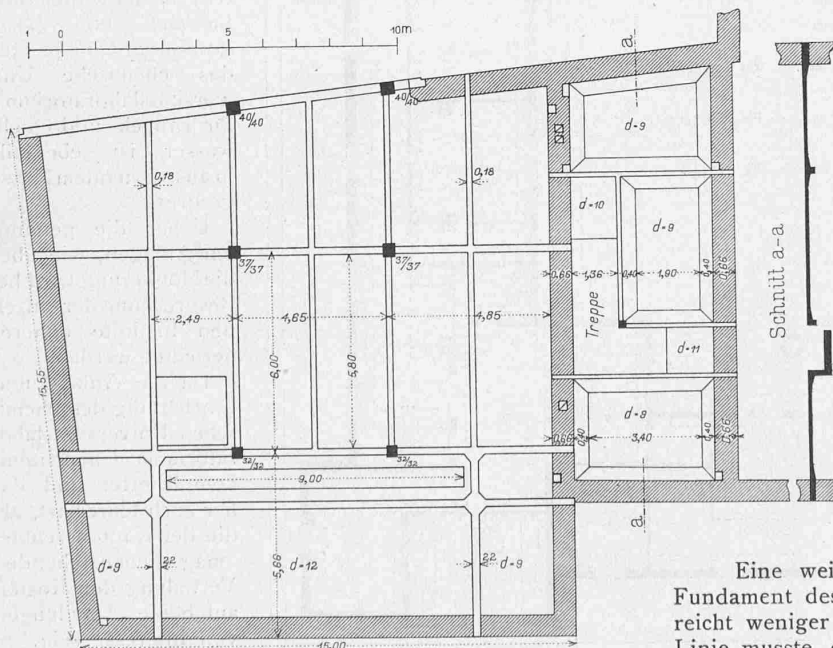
Grundriss des I. Stocks von Magazin I (u. Treppenhaus) mit Aufzugöffnung und Transportschlitz I. — Masstab 1 : 200.
